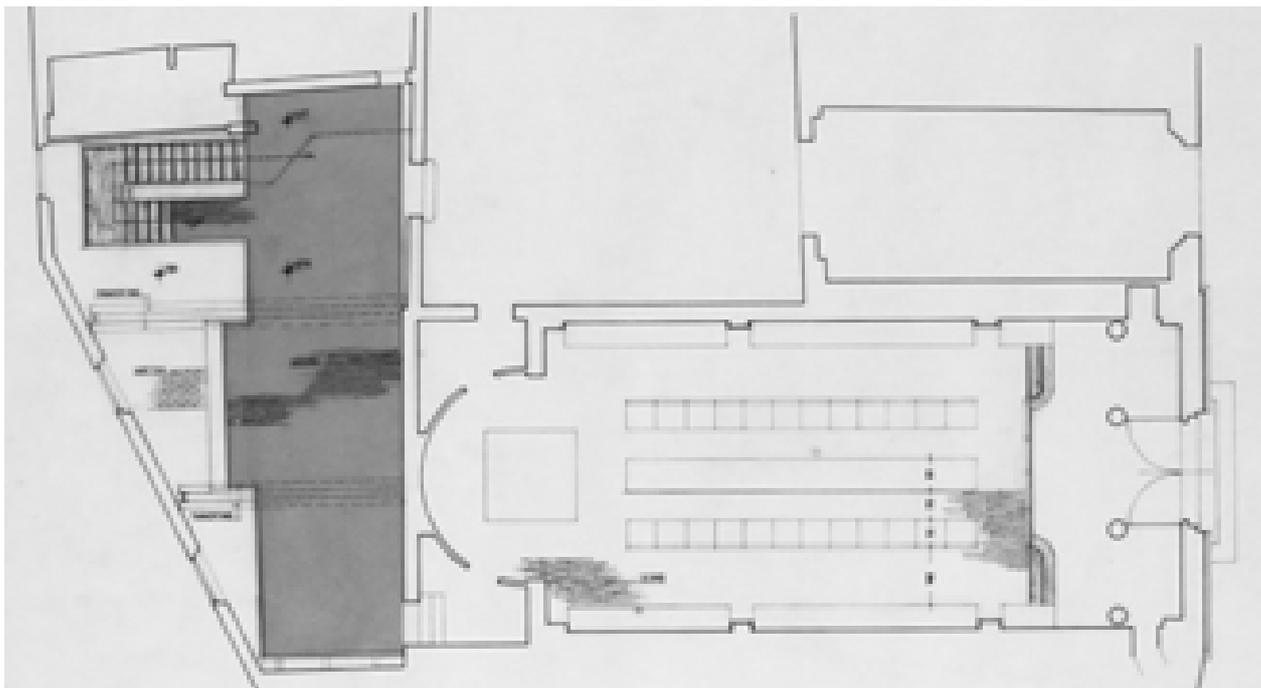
San Leonardo studio per museo e archivio, pianta +2,72 – s.d. (AABS-94.0146)
